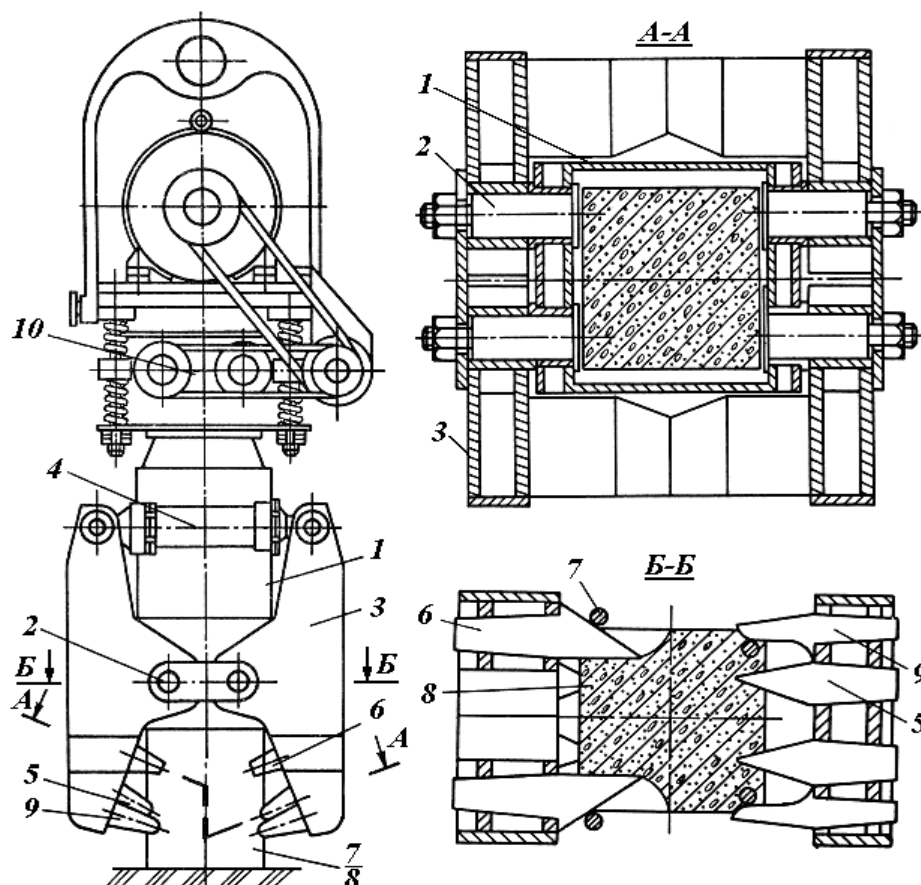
Устройство для срезки свай с сохранением арматуры над срезом
